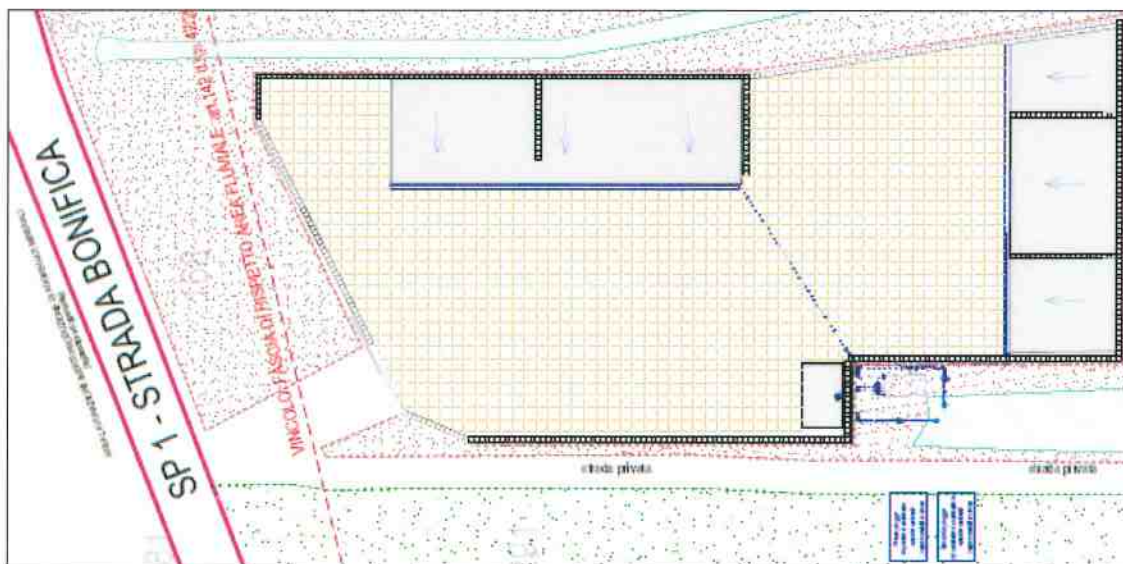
Schema delle pendenze aree pavimentate (da elaborato 2 allegato allo SPA)
